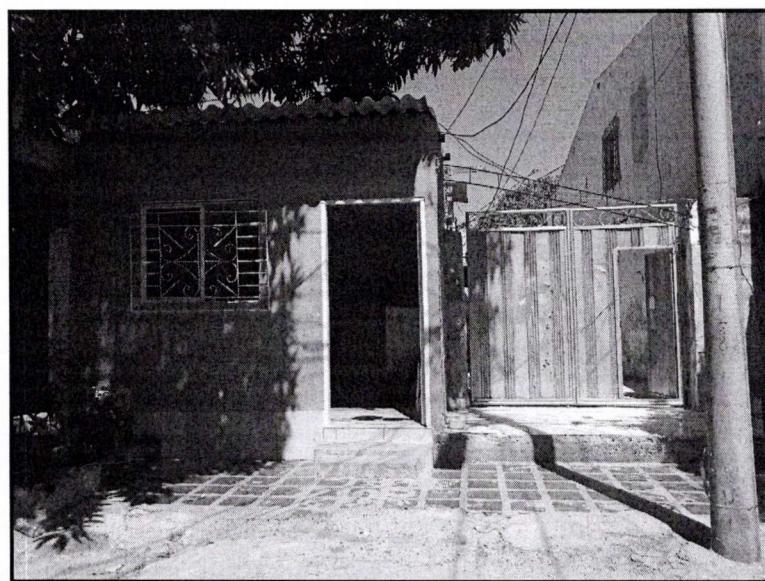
FOTO ANTERIOR DE LA FACHADA DE LA VIVIENDA DEL SEÑOR FRANK WONG CARDENAS
